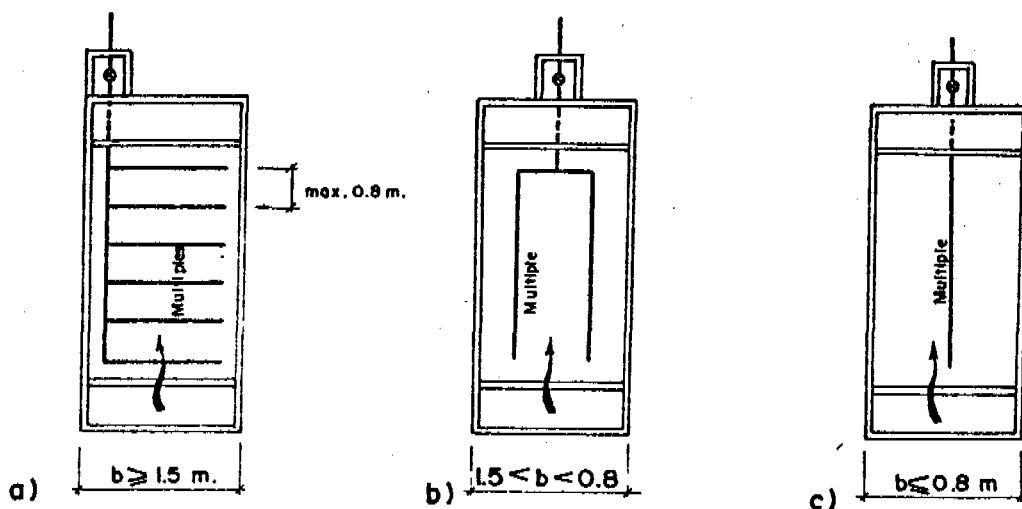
Alternativas para colocar el sistema de drenaje en los FGD₁.
